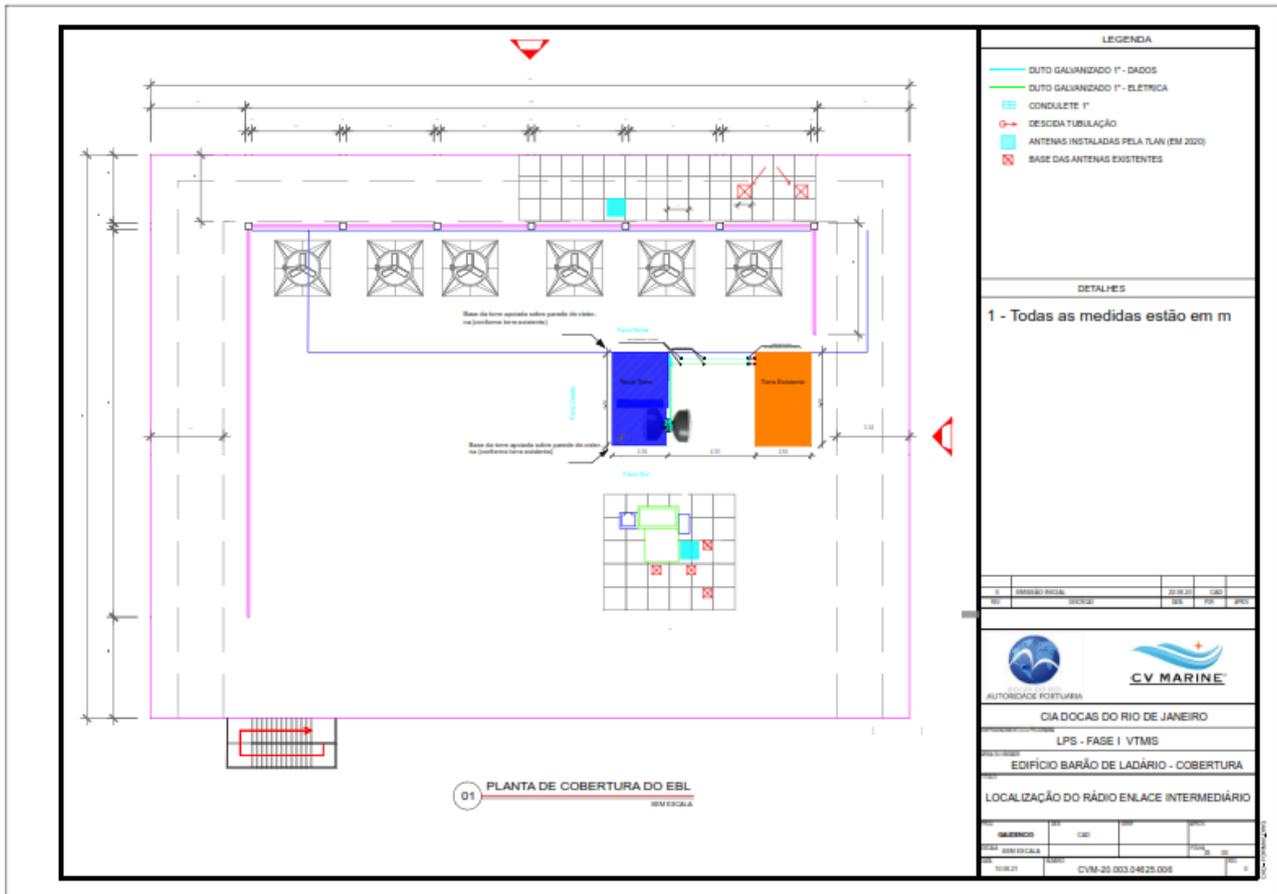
Planta de localização do Radio Enlace Intermediário – Edifício Barão de Ladário.
